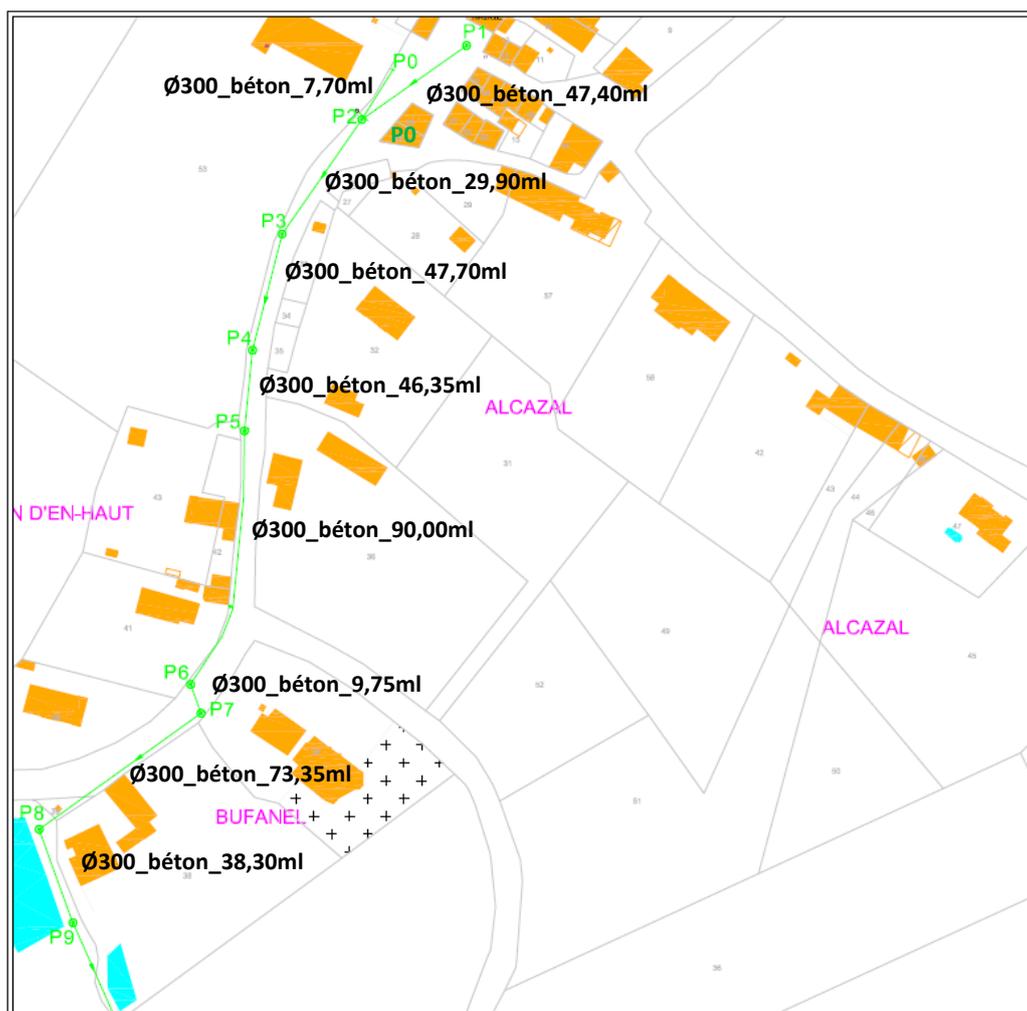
PLAN DE SITUATION DU RESEAU PLUVIAL DE MAURENS
